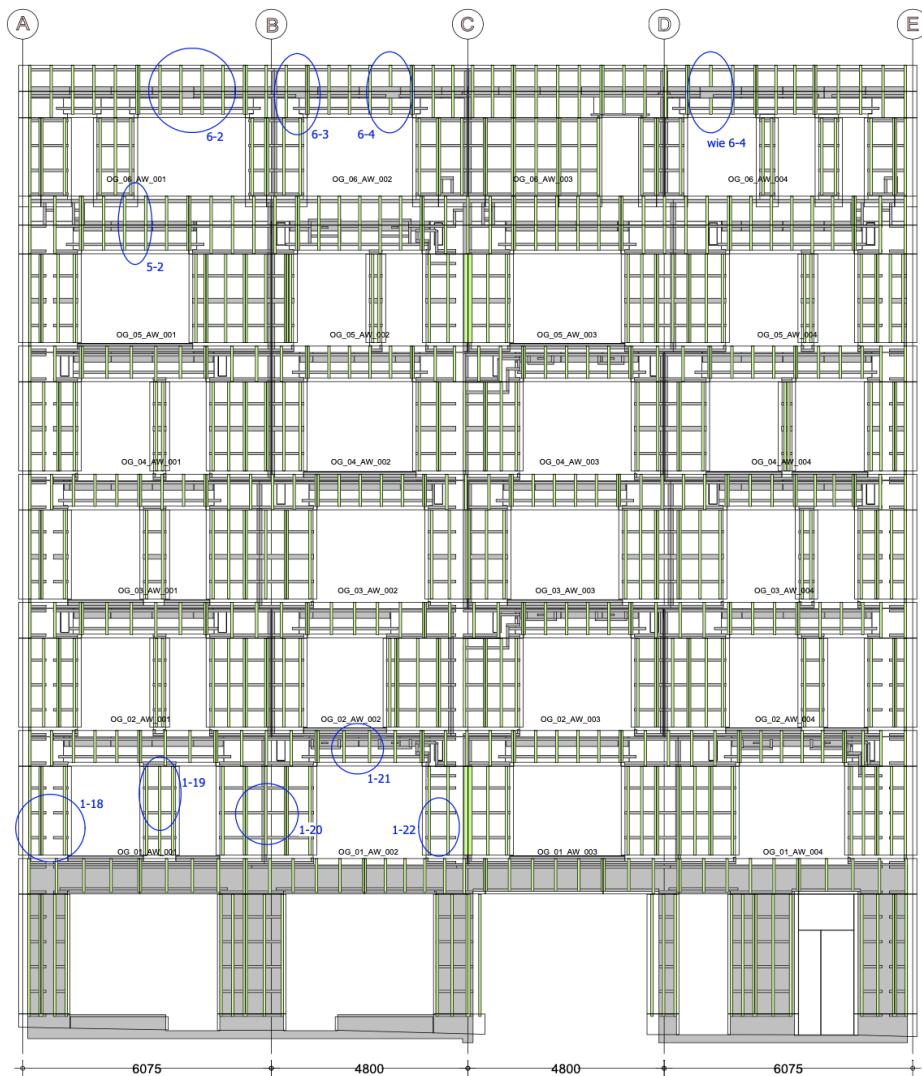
Werkplanung Fassaden, Unterkonstruktion – Verfasser: Prause Holzbauplanung, Lindlar (D)
